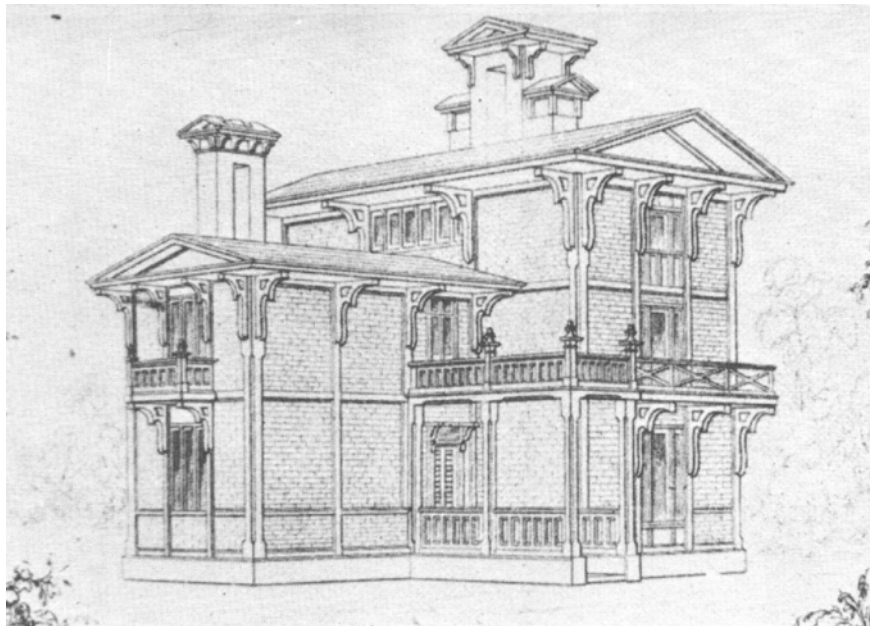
zeigt den Entwurf einer Cottage-Villa. Auffällig ist die geringe Größe des Baukörpers und die (einfache) Holzrahmenbauweise. Im Vergleich zu historistischen Vorstadt villen (vgl. Kap. 5.2.5 Grundriß und Gebäudeaufteilung) kann das Raumprogramm hier nur bescheiden gewesen sein.
